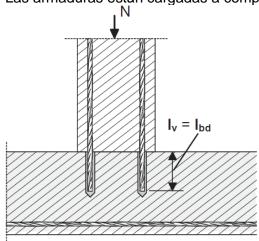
Conexión de armaduras para elementos sometidos a compresión. Las armaduras están cargadas a compresión.
